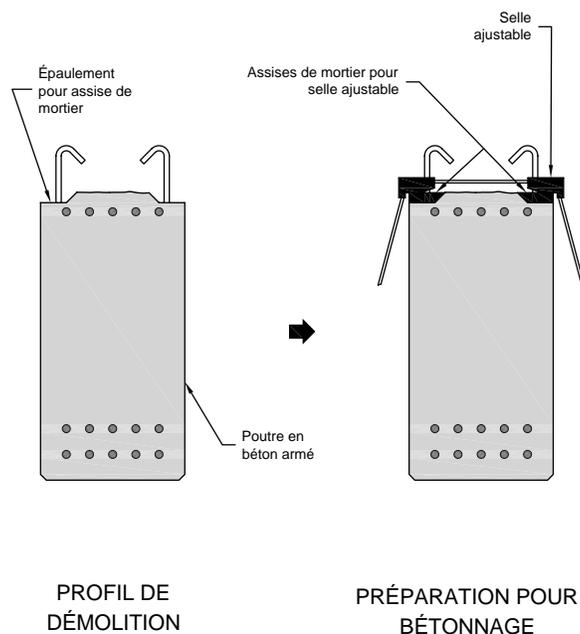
Démolition – Dessus de poutre en béton armé
